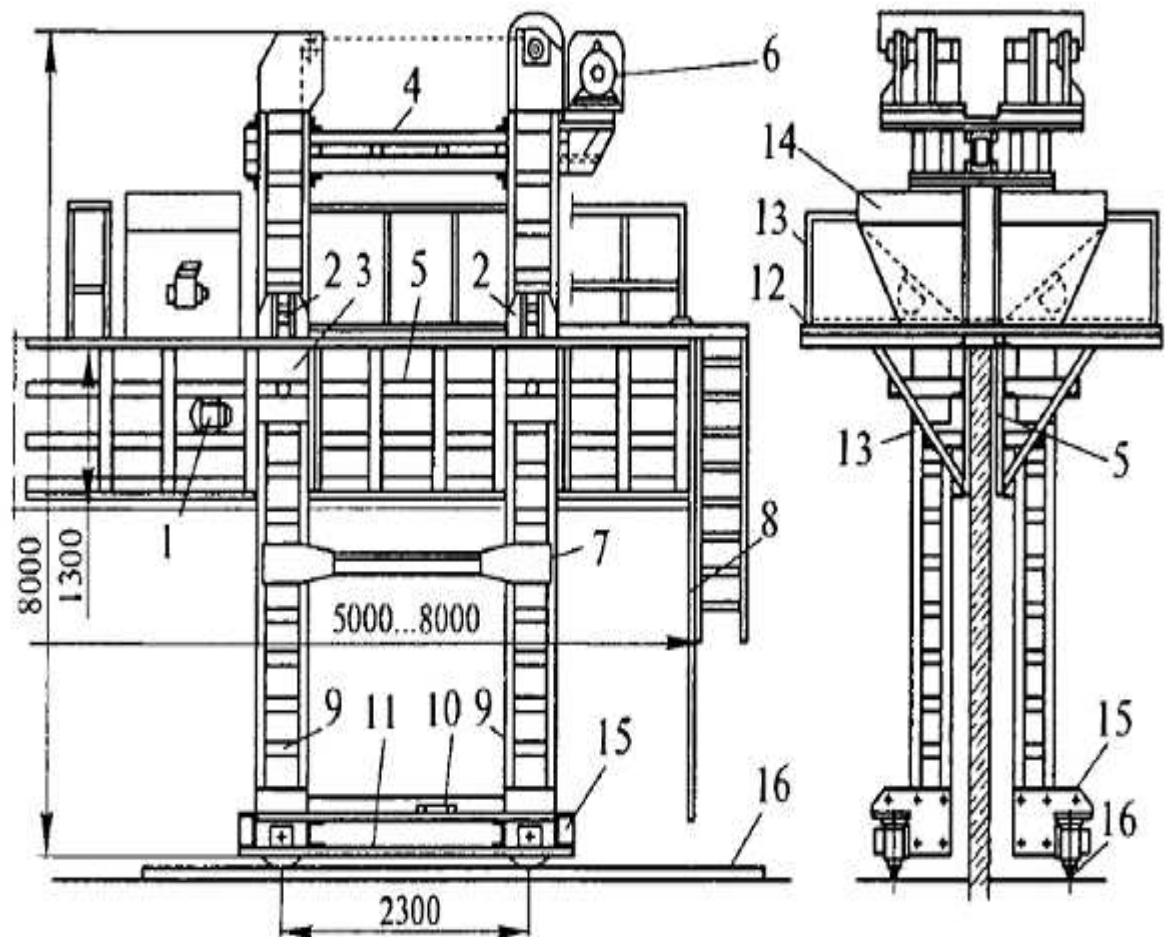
Котюча опалубка для бетонування підпірних стін:
